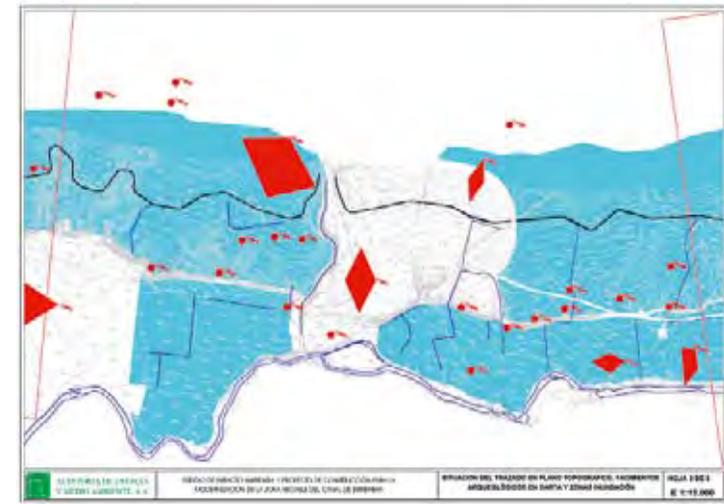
Planimetría con ubicación de yacimientos arqueológicos (Canal de Estremera).
